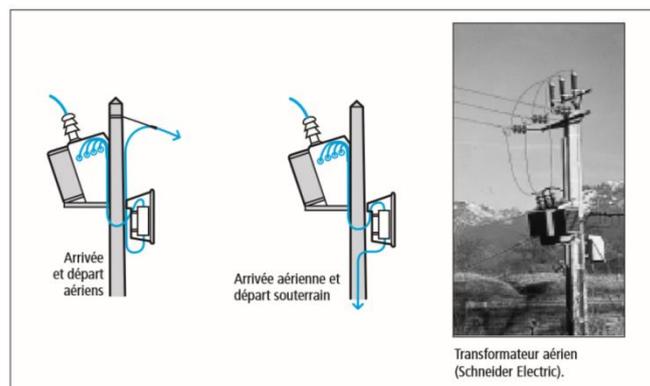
Exemple de raccordement d'un poste sur poteau [13]
